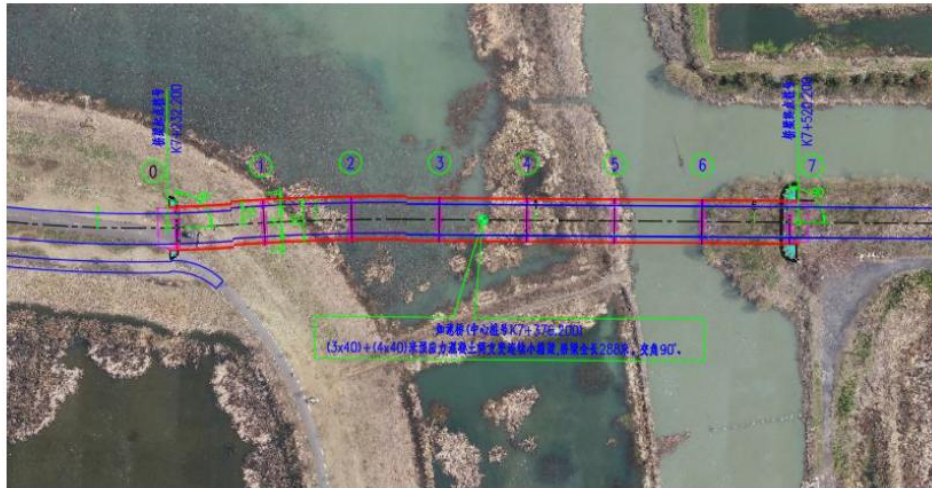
(3x40+4x40) m 预应力混凝土小箱梁平面图
